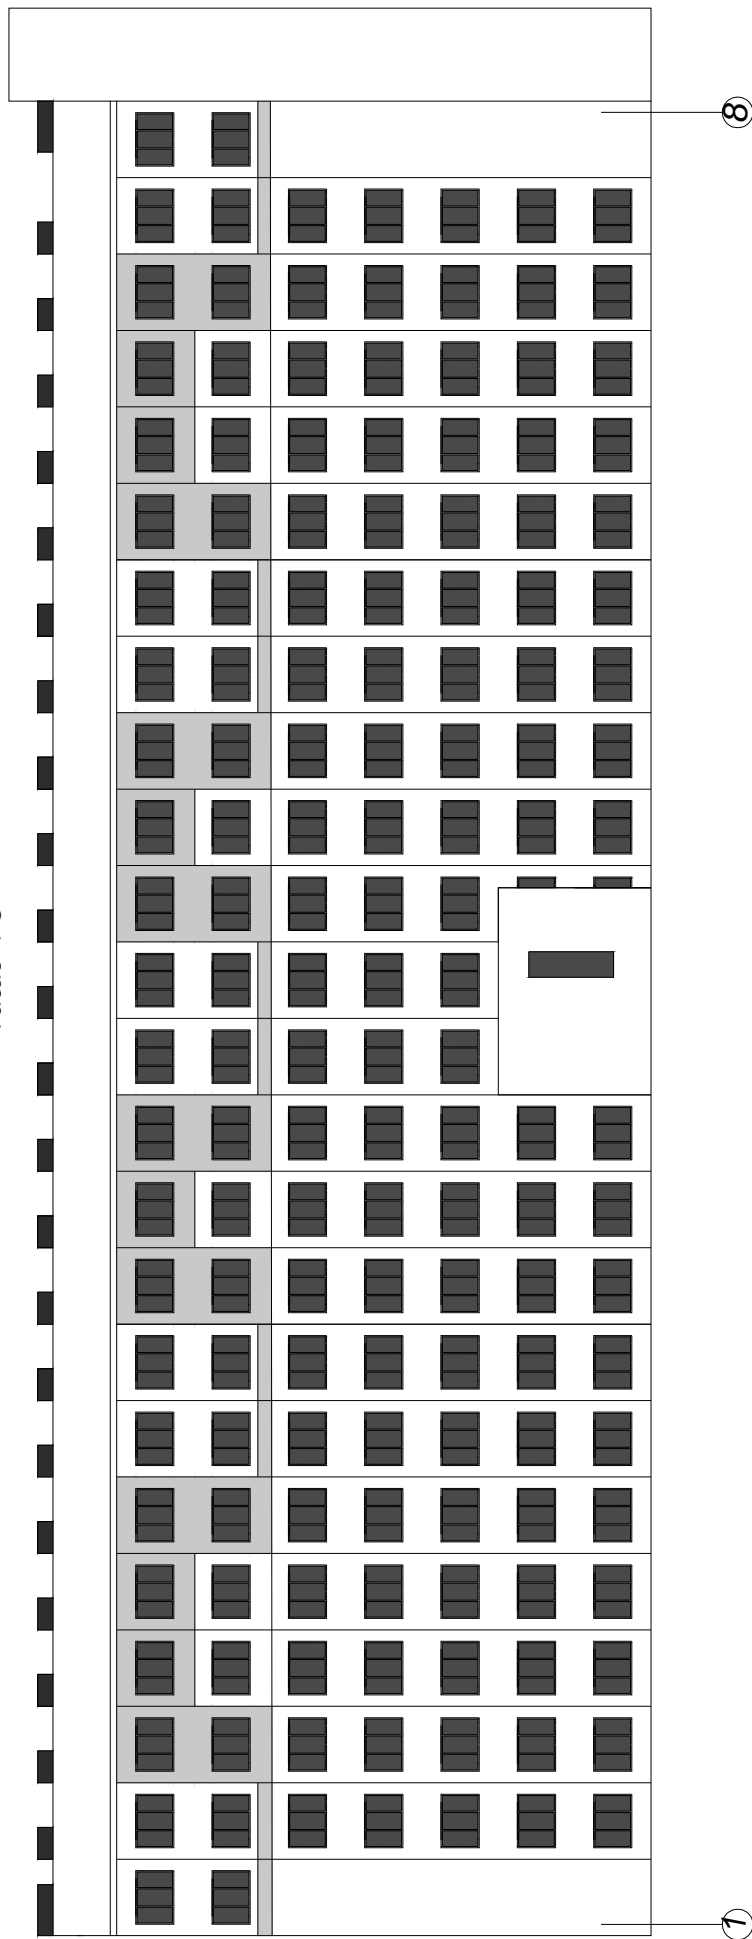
Общий вид здания с надстройкой 6-го и 7-го этажей
